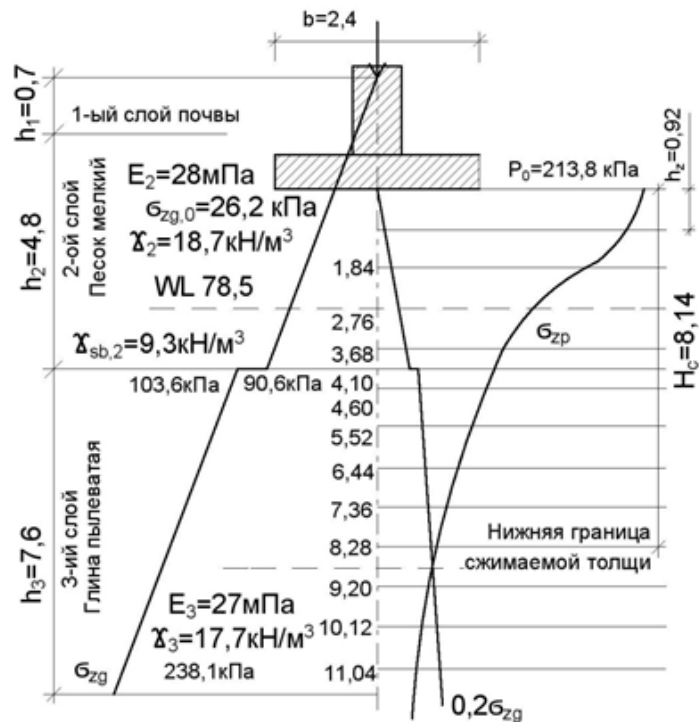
Расчетная схема осадки ленточного фундамента
